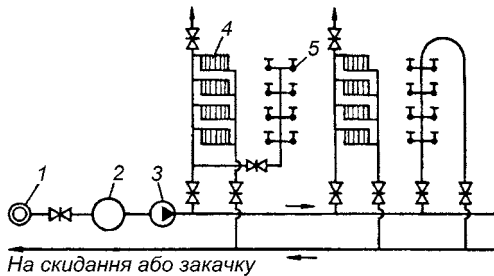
Відкрита двохтрубна геотермальна система теплопостачання: 1 – геотермальна свердловина; 2 – бак-аккумулятор; 3 – мережний насос; 4 – опалювальні прилади; 5 – водорозбірний кран
